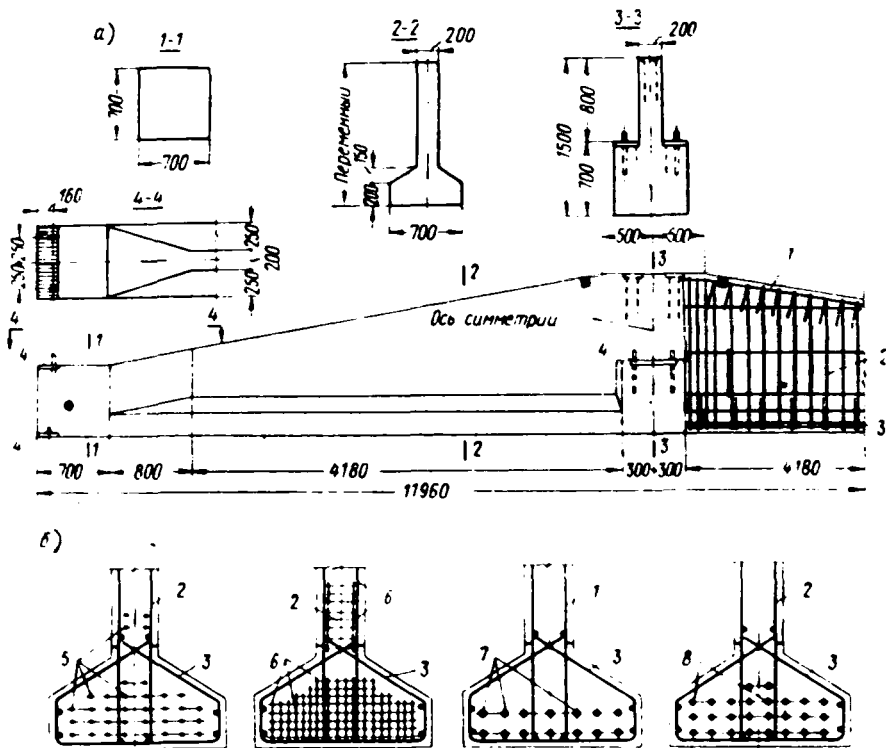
Типовые подстропильные балки серии ПП-01-03/64
